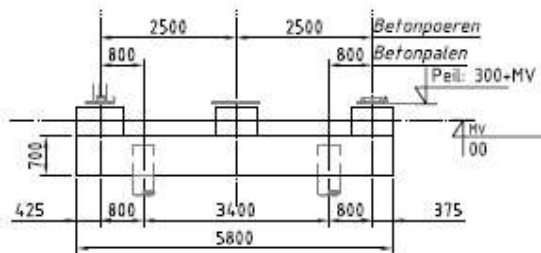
Zijaanzicht fundatiebalken OSP mast 11
